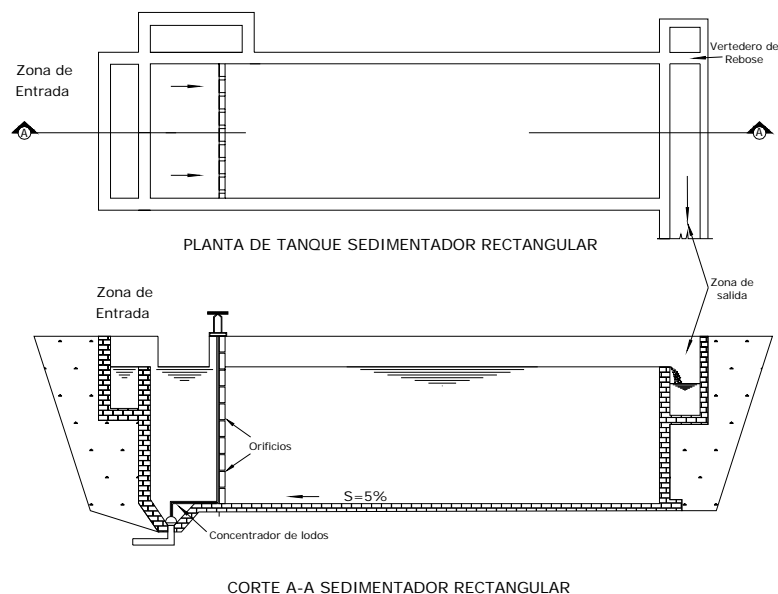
Esquema general de un tanque de sedimentación rectangular de flujo longitudinal
